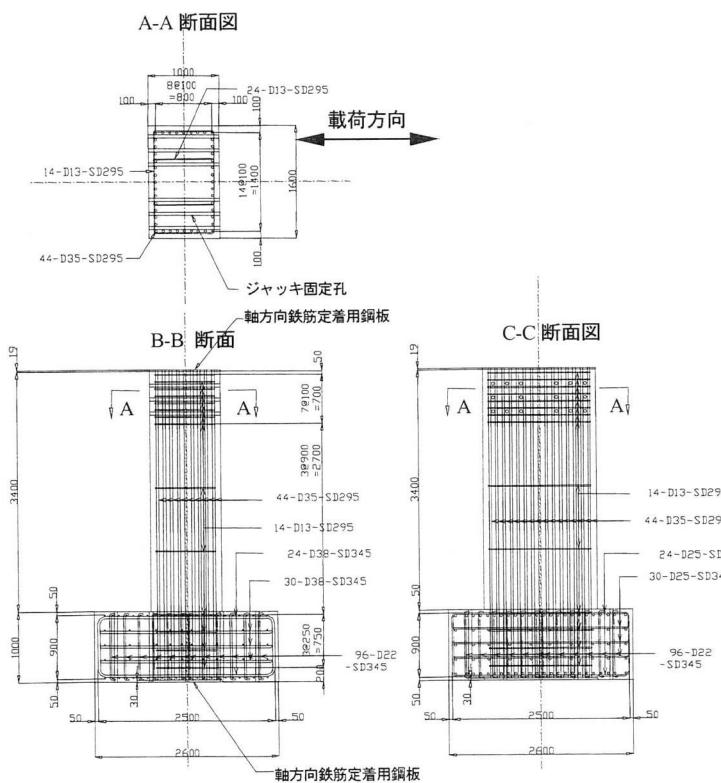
実験供試体配筋図（無補強時：せん断破壊先行）
